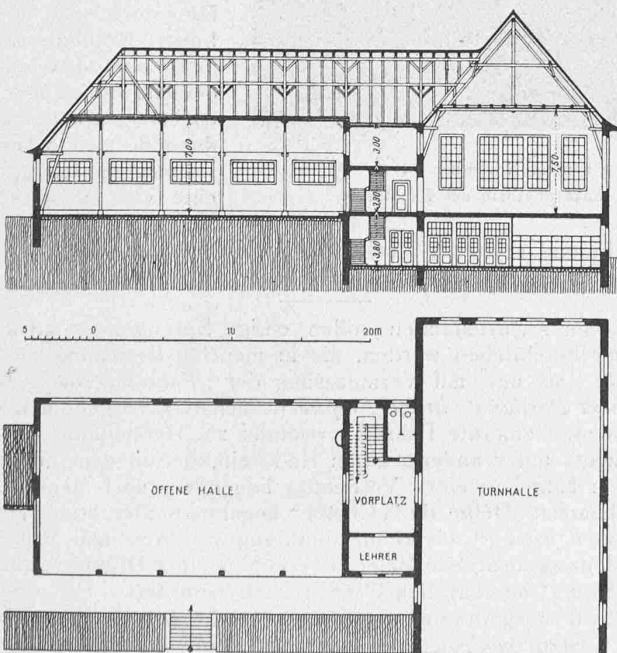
bis 11. Grundrisse und Längsschnitt durch das Turnhaus Heiligberg. — 1:500.
